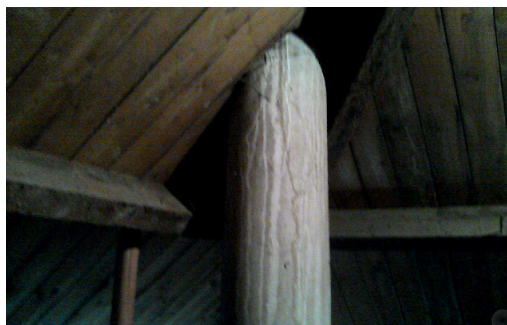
Asbesthoudende pijp. Dakconstructie en dakbeschoot van hout
